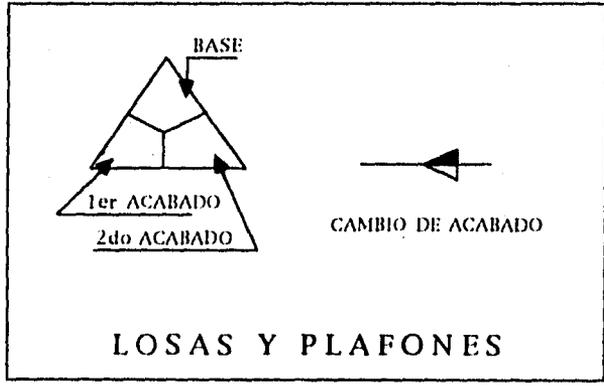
Nomenclatura para acabados en losas y plafones.
